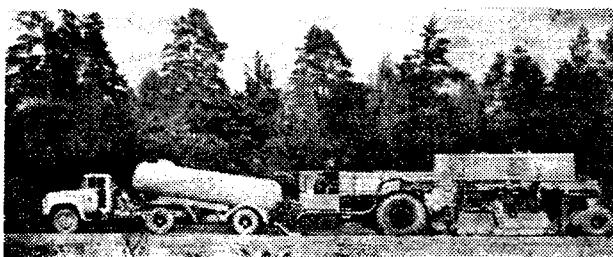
Работа грунтосмесительной машины Д-391Б при укреплении грунта цементом
